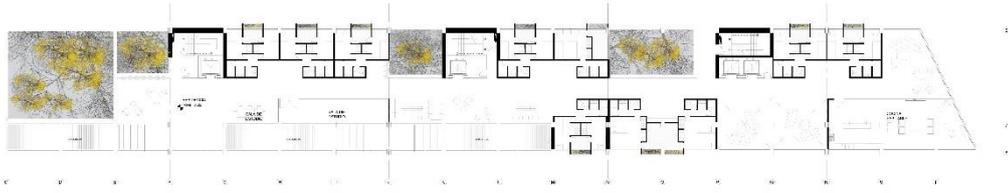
Planta tipo. Nivel + 9.00. Elaboración propia
